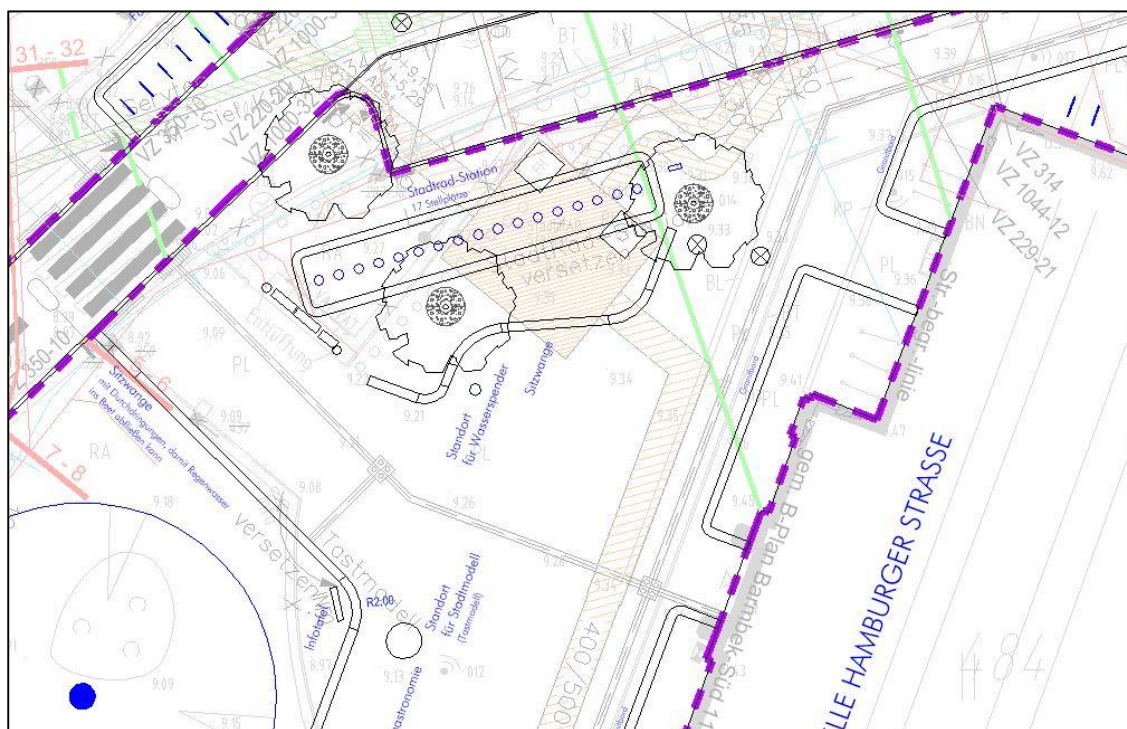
Lageplanausschnitt mit Darstellung der unterirdischen Fernwärmeanlagen und Elektroleitungen
